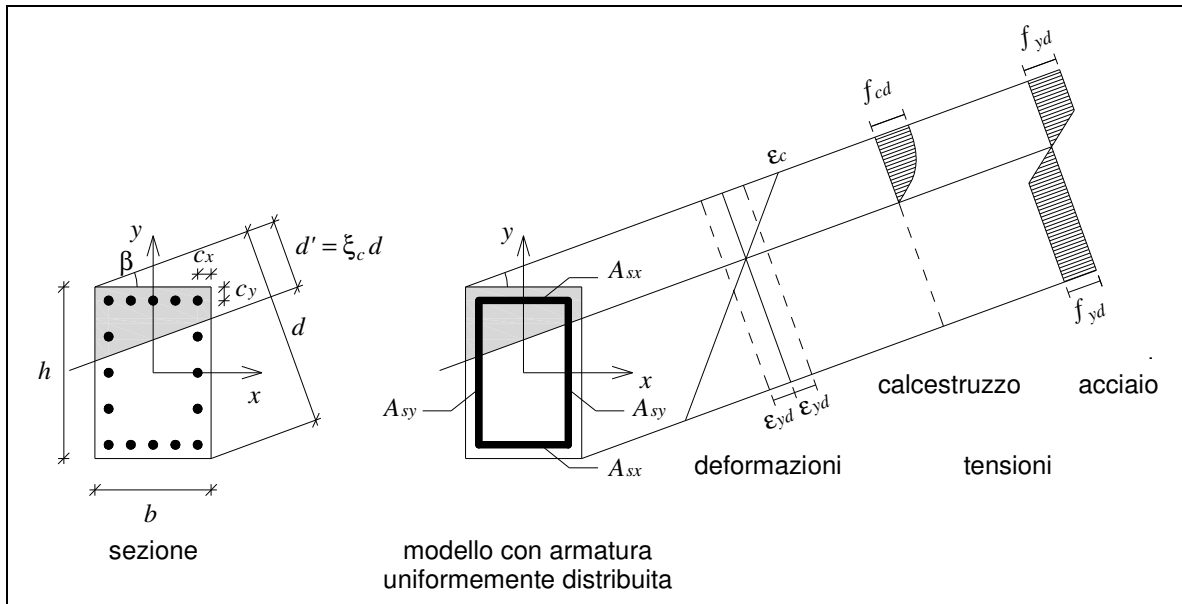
Stato tensionale e deformativo in una sezione rettangolare con armatura doppia simmetrica soggetta a pressoflessione deviata
